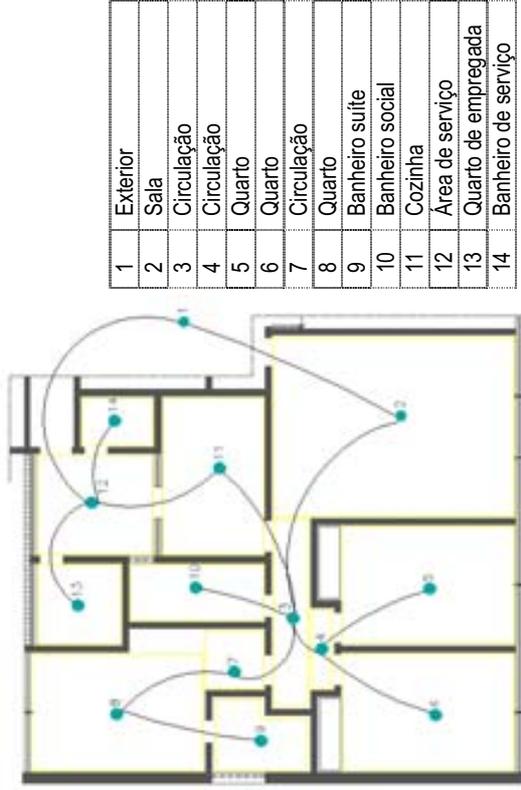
SQS 303 – Bloco C – Asa Sul – Planta Original
